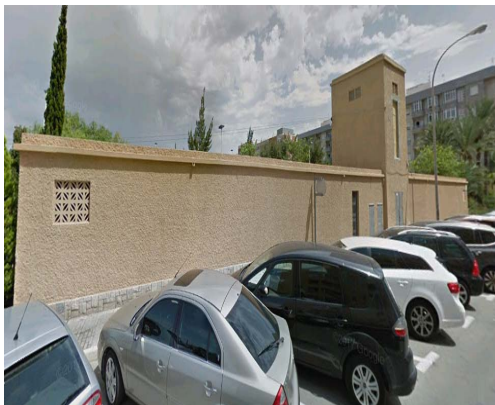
Fachada de bloque de hormigón con tirolesa- Zócalo de azulejos y enlucido
